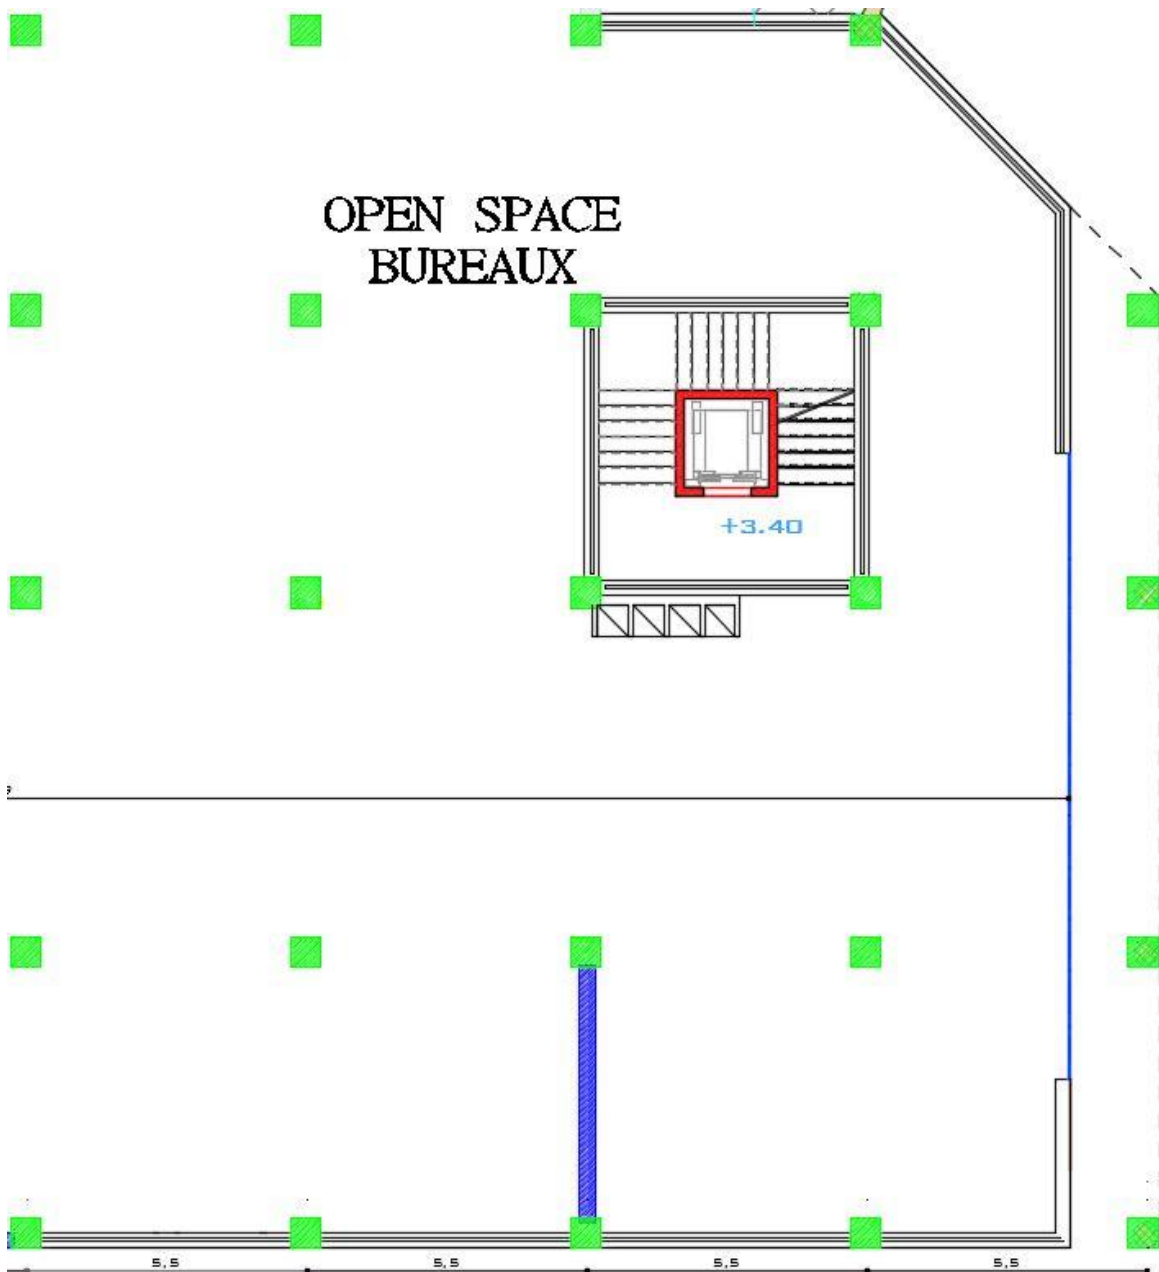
vue en plan niveau 1 ère étage open space bureau
